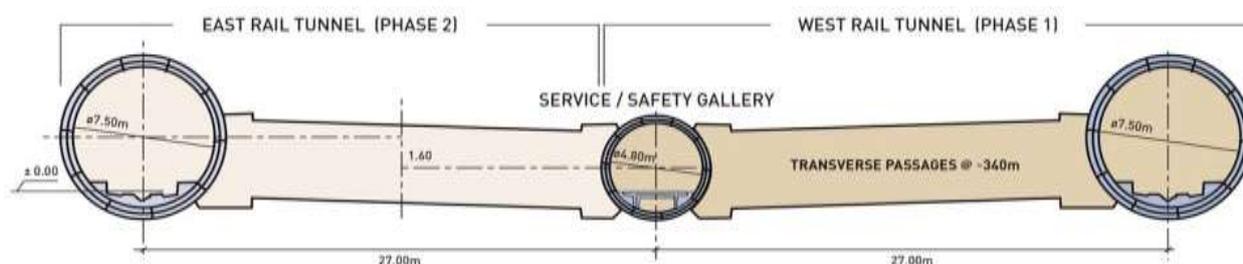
Ipotesi di progetto della sezione del tunnel di Gibilterra
